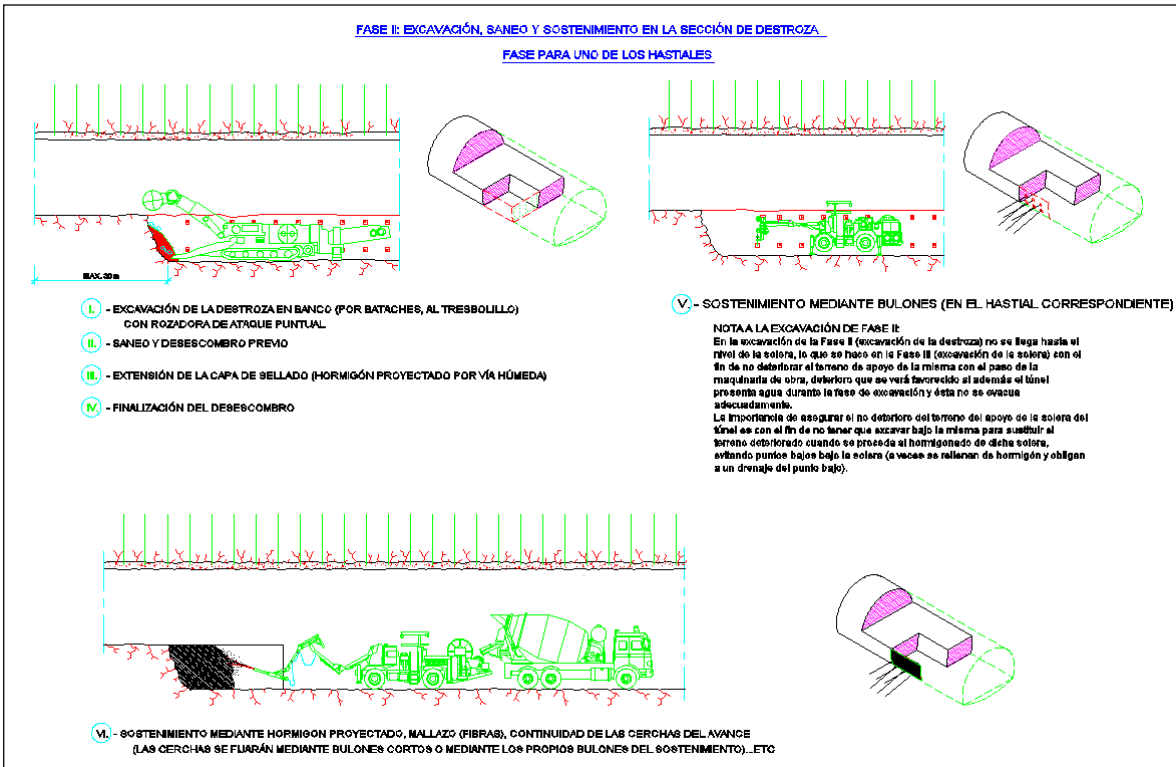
Fase de excavación en la sección de Destroza, primer hastial
